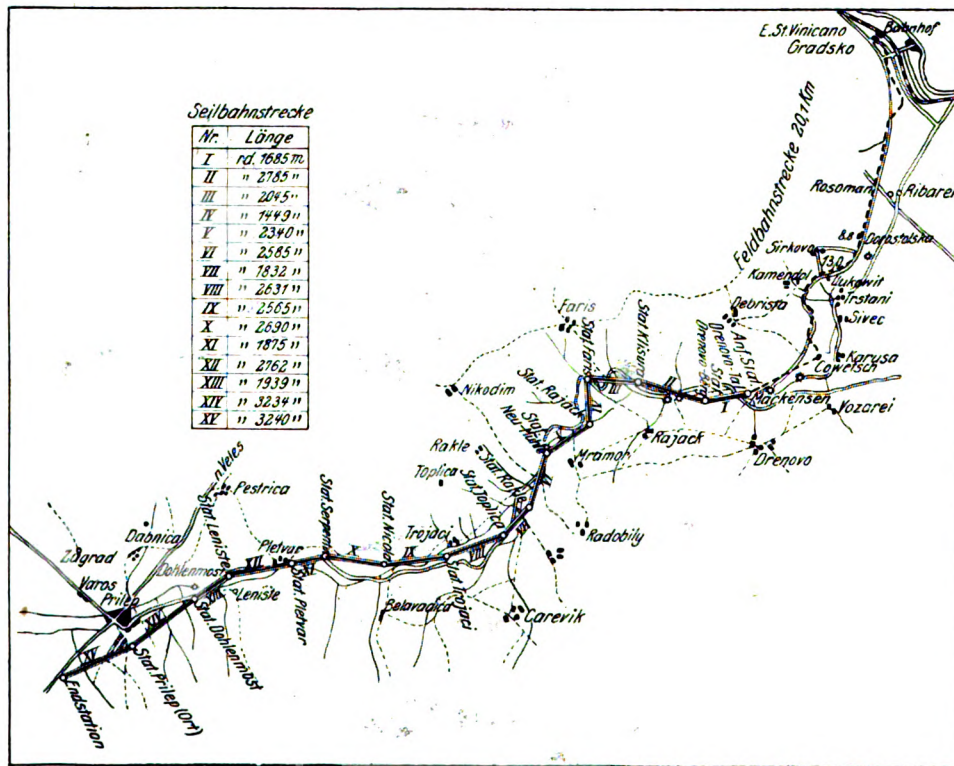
Seilbahn Drenowo-Prilepp, Lageplan.
